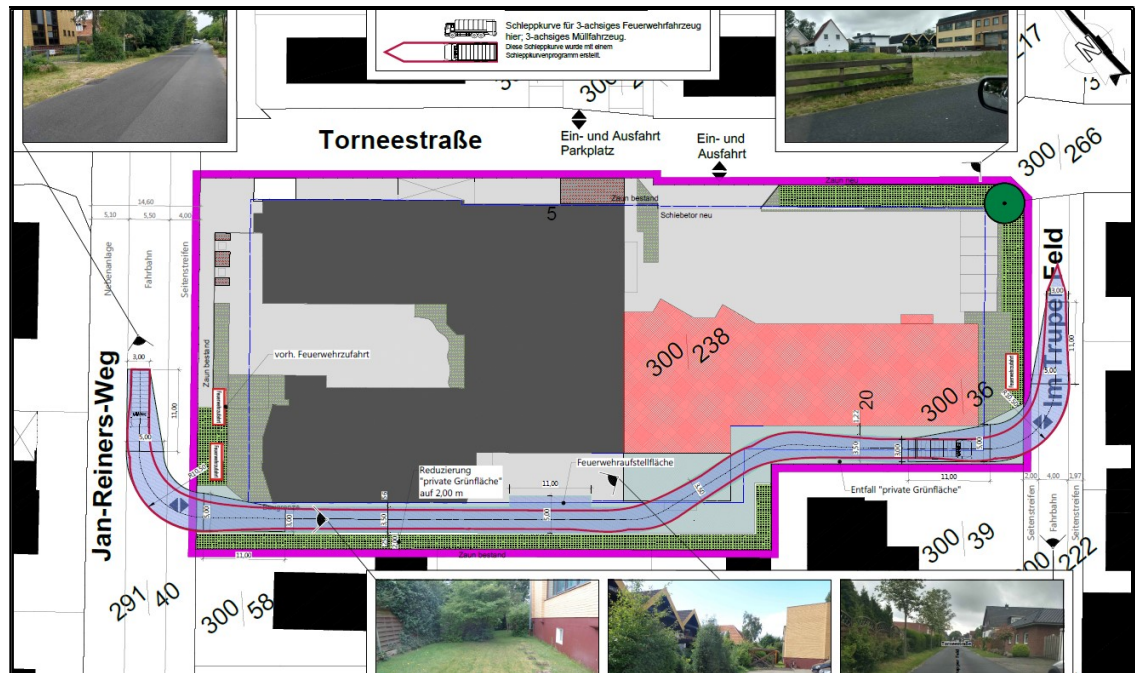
Lageplan zur Feuerwehrumfahrung (Fahrspur gemäß DIN 14090). Die im Osten skizzierten Stellplätze werden nicht umgesetzt, da sich die erforderliche Anzahl an Einstellplätzen gemäß § 47 NBauO bereits nördlich des Geltungsbereiches befindet (Quelle: Umtec, Bremen, Stand: 30.07.2019). Karte verdeutlicht nur die Feuerwehrumfahrung. Aktuelle Hallengröße sowie aktueller Ein- und Ausfahrtsbereich sind der Abbildung 6 zu entnehmen.
